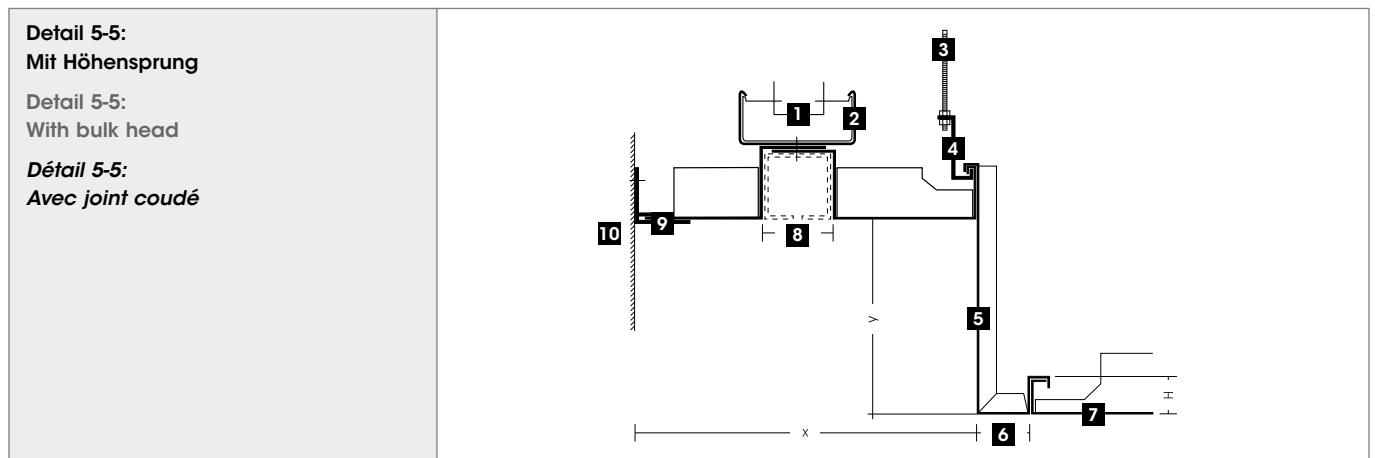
DETAILS-WANDANSCHLÜSSE DETAILS-WALL CONNECTIONS DETAILS CONNECT. MUR
